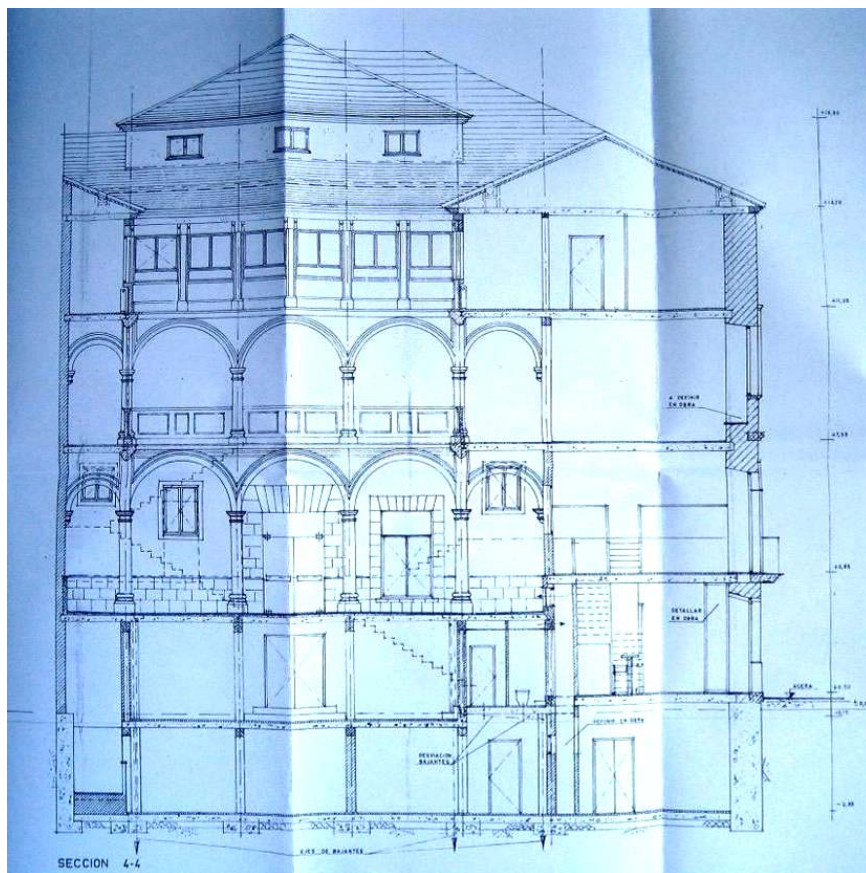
Palacio de los Salcedo. Sección del nuevo edificio. Se puede observar la tercera planta de la galería añadida. *Proyecto de reconstrucción del patio antiguo y restauración de fachadas en el Palacio de Montemar.* AGA, IDD (4)117 caja 51/11841.
